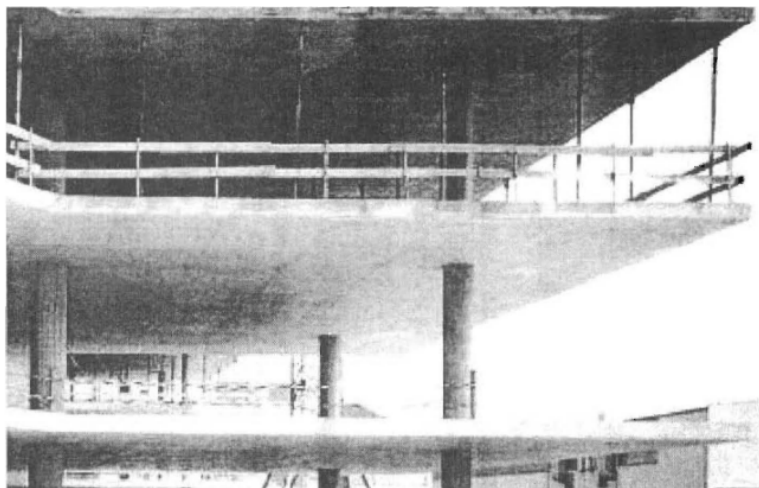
Obra de edificación usando losas de hormigón planas [3]
